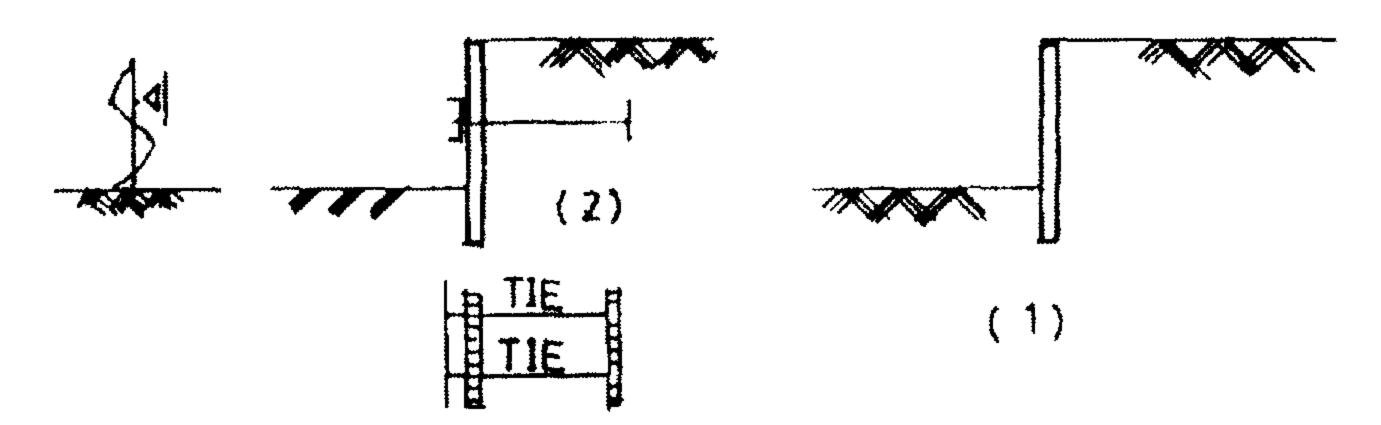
مقارنة مع شكل الحائط الخرساني الساند
